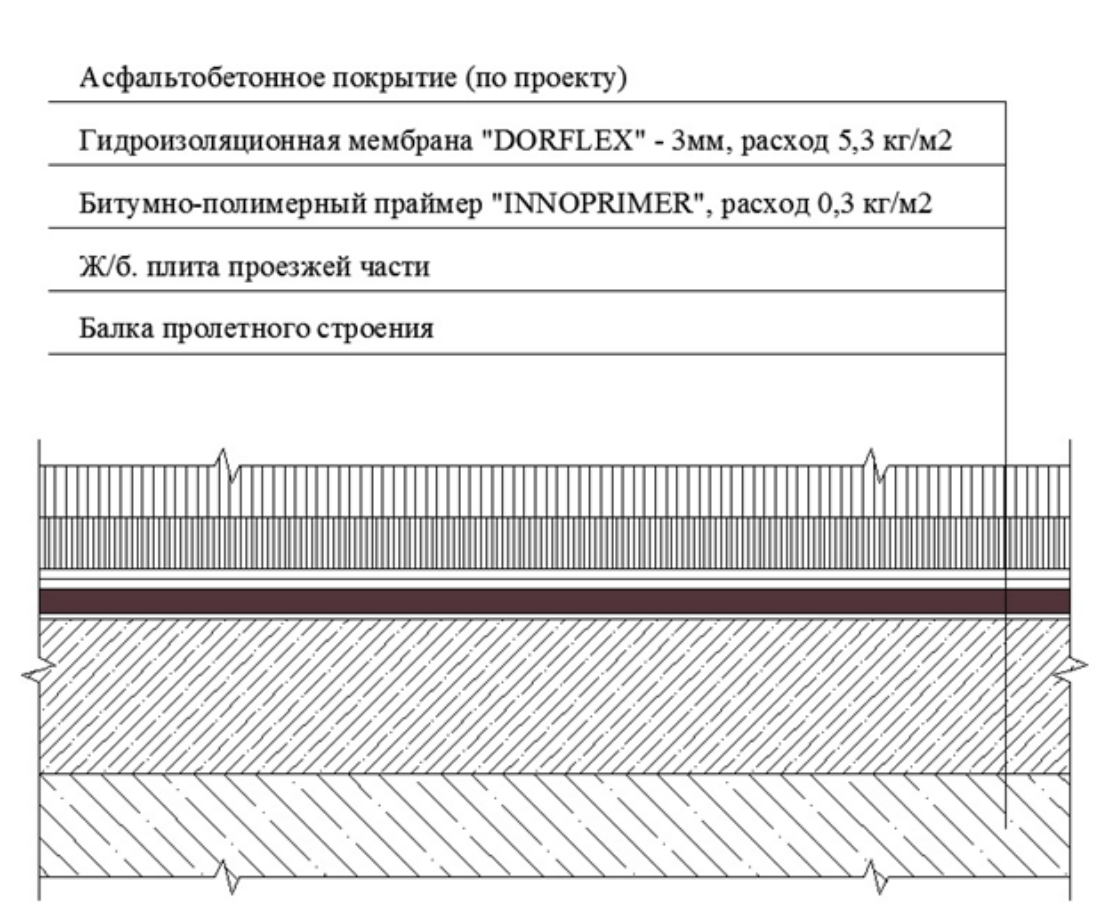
Гидроизоляция железобетонной плиты мостового сооружения.
